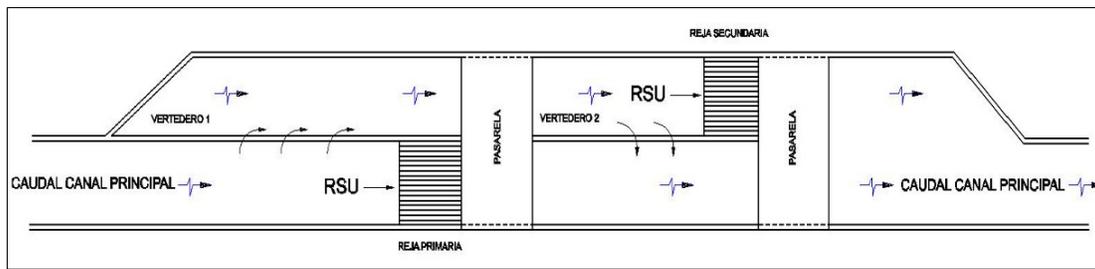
Croquis Típico de una Trampa de Basura construida sobre un canal de distribución
